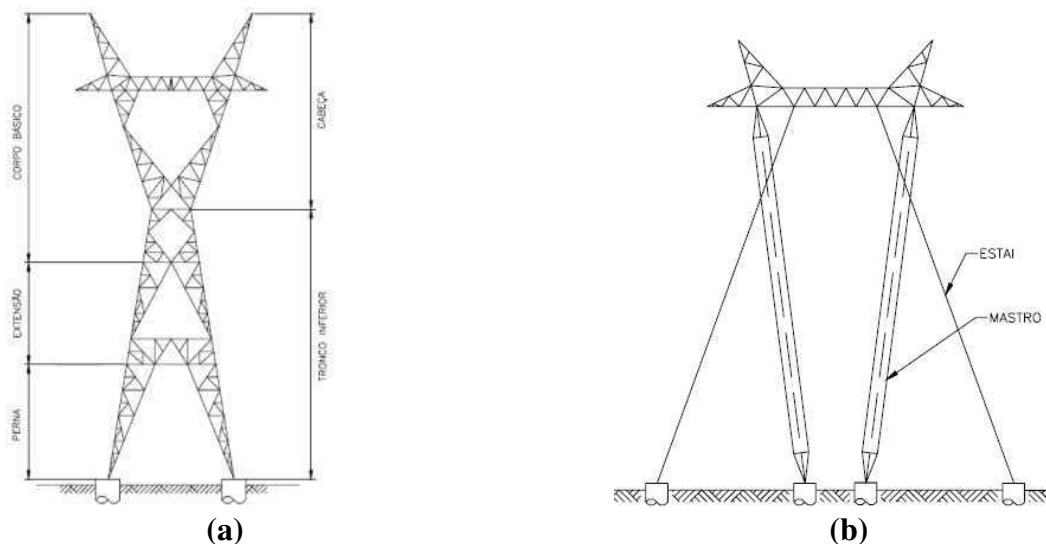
Silhuetas de estrutura (a) metálica autoportante; (b) metálica estaiada.
